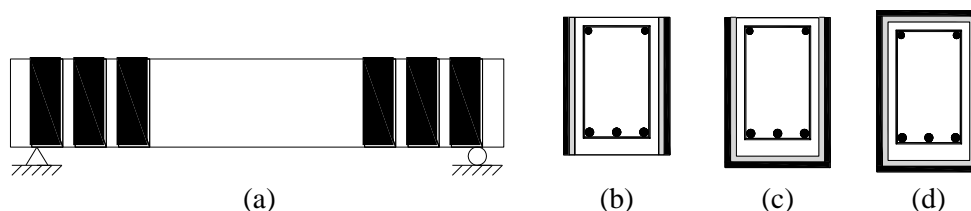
Viga de concreto armado reforçada ao cortante
